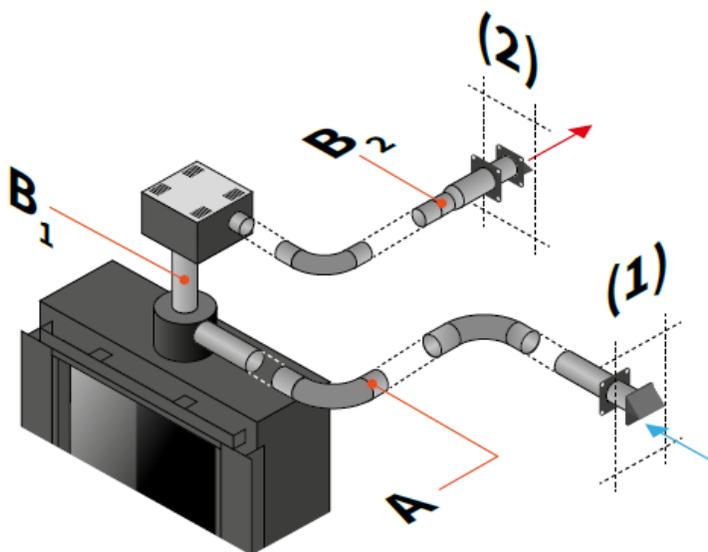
Adaptador directamente sobre la chimenea y con terminal horizontal en otra zona
